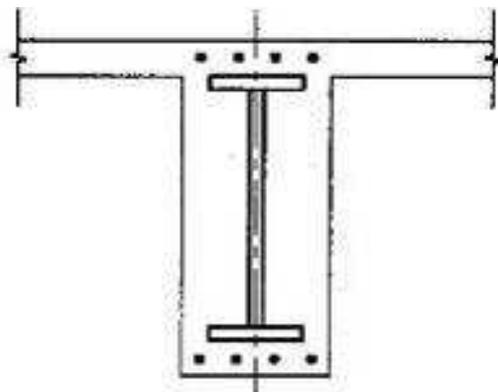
Поперечное сечение железобетонной балки с жесткой арматурой из стальных профилей
